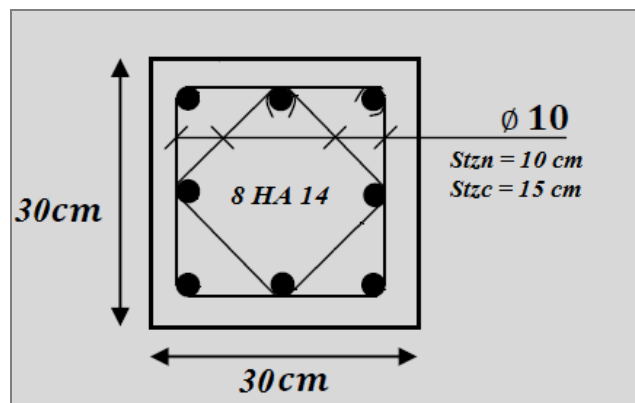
Schéma de ferrailage de poteau 30×30.
